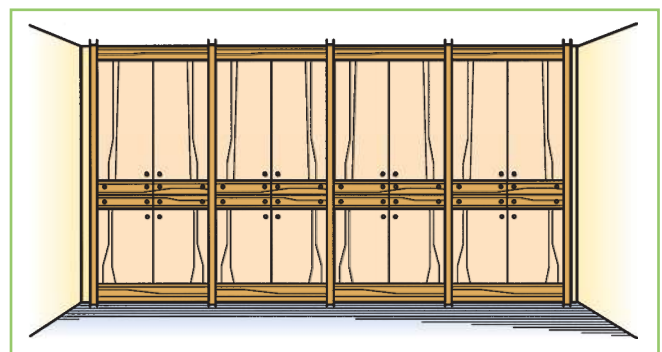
Schrankwand mit vorwiegend horizontaler Betonung
